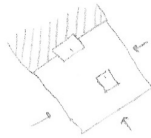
Boceto en planta de la geometría de la construcción situada en la Rúa Eugenio Kraff, nº 11 (autoría propia).
